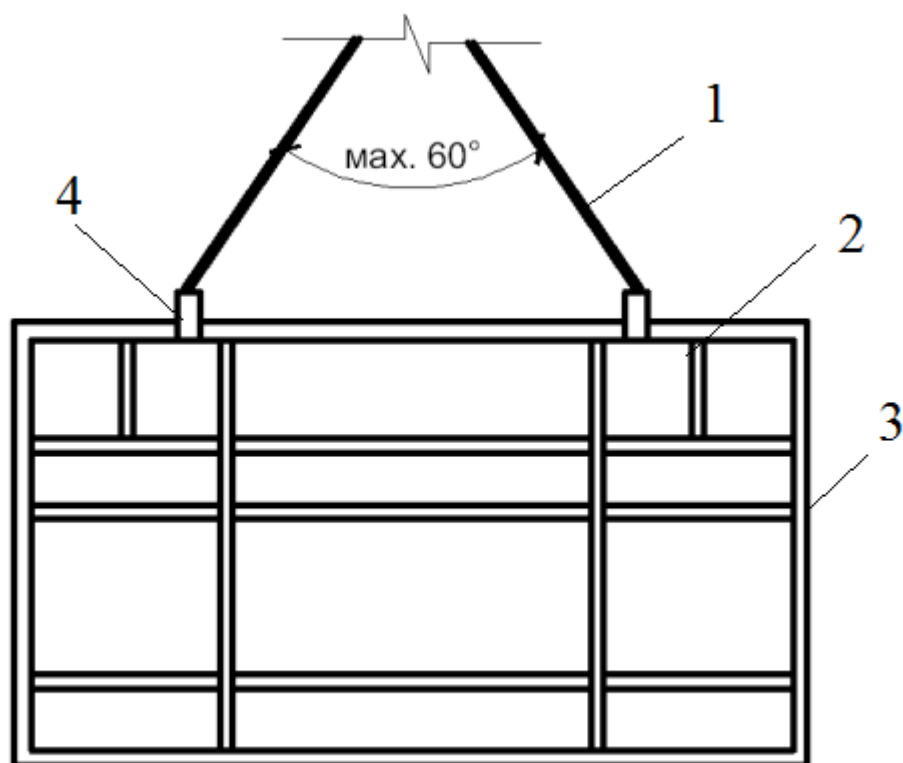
Схема строповки щита опалубки при подаче к месту монтажа
